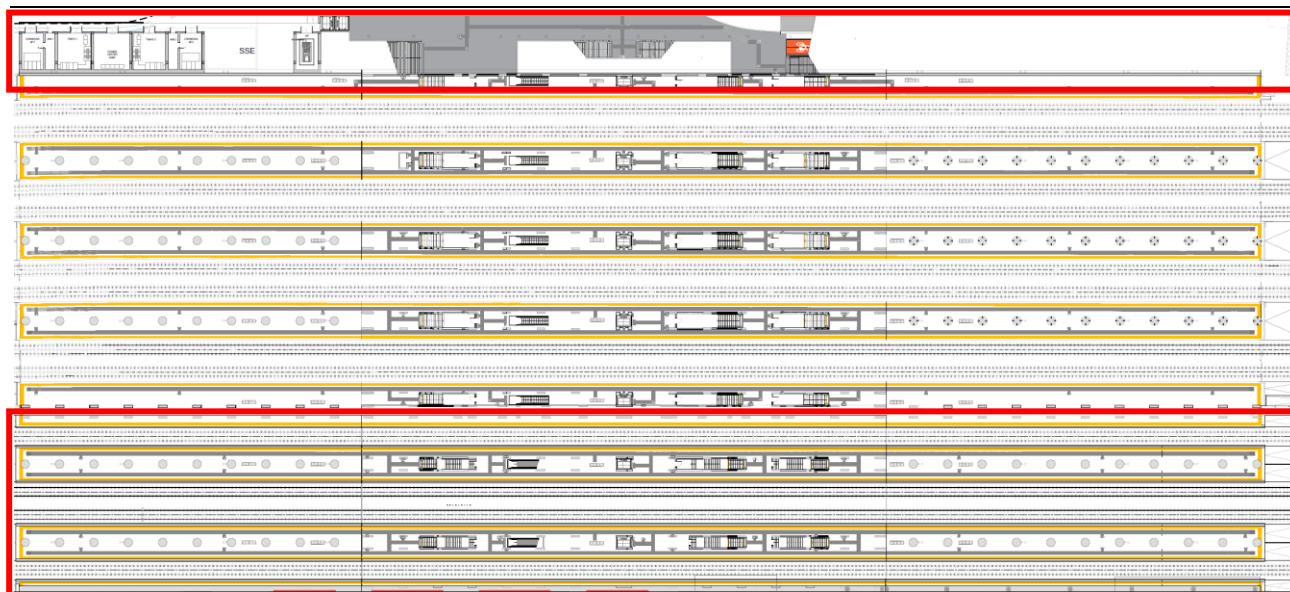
Pianta Piano Banchine e cabina di stazione con indicazione dell'ampliamento.
